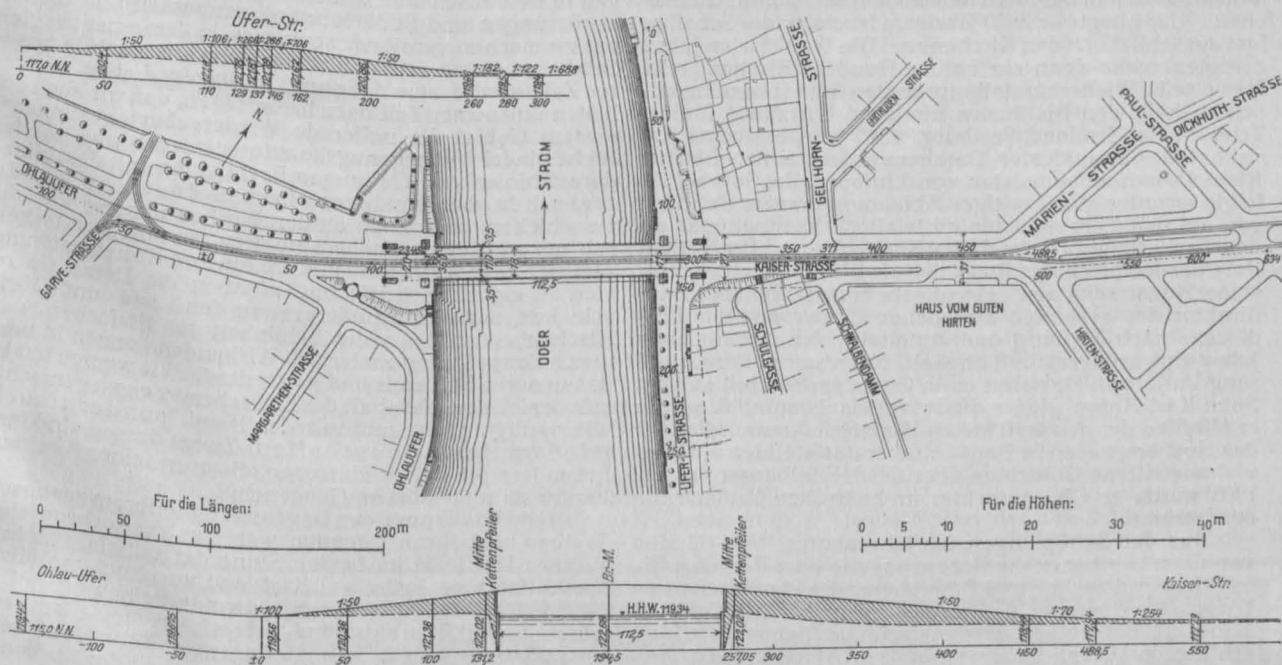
Lageplan der Brücke nebst Höhenplänen.
